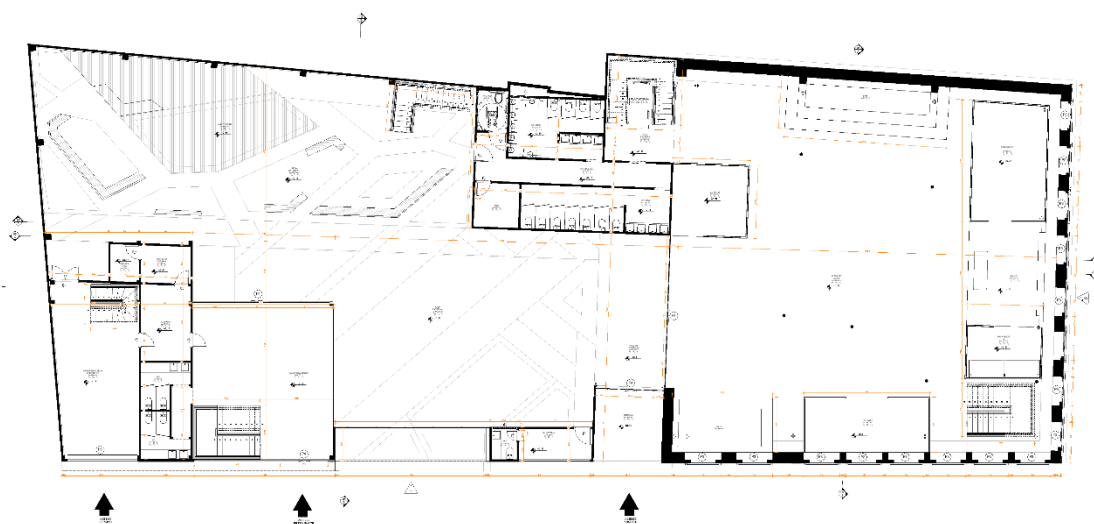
Planta Baixa, Térreo, Fonte: Elaboração Autoral, 2023
